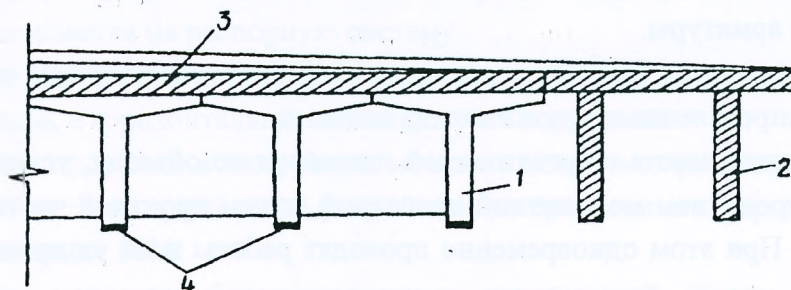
Усиление дополнительными балками: 1 – балки старого пролетного строения; 2 – дополнительные железобетонные балки; 3 – монолитная плита; 4 – металлическая арматура усиления.
